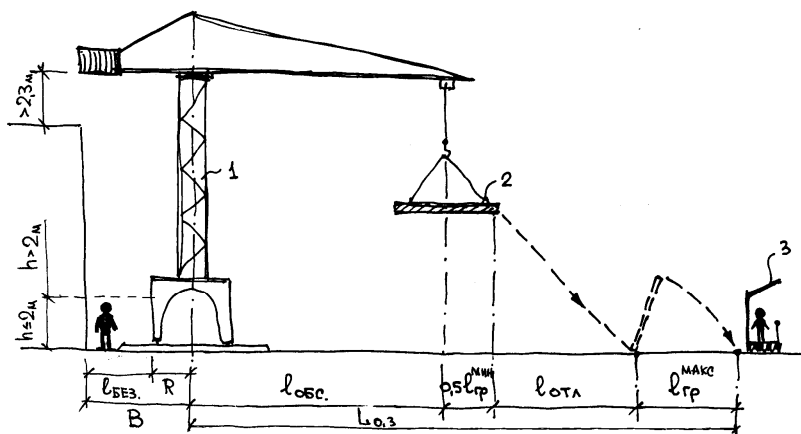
Схема определения безопасной поперечной привязки крана и опасных зон его работы.
